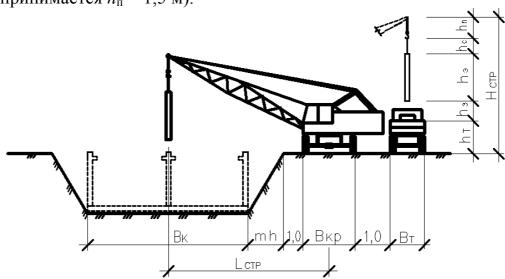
Схема определения монтажной высоты и вылета стрелы крана при расположении крана на бровке котлована
